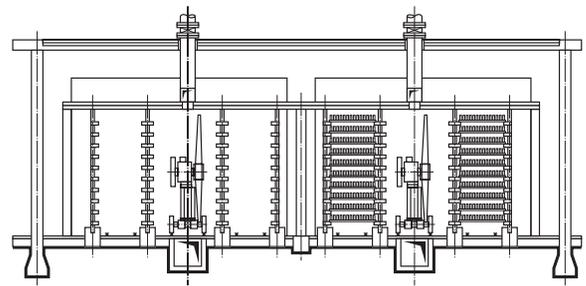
Реконструкция сушильной камеры с использованием осевых вентиляторов.
